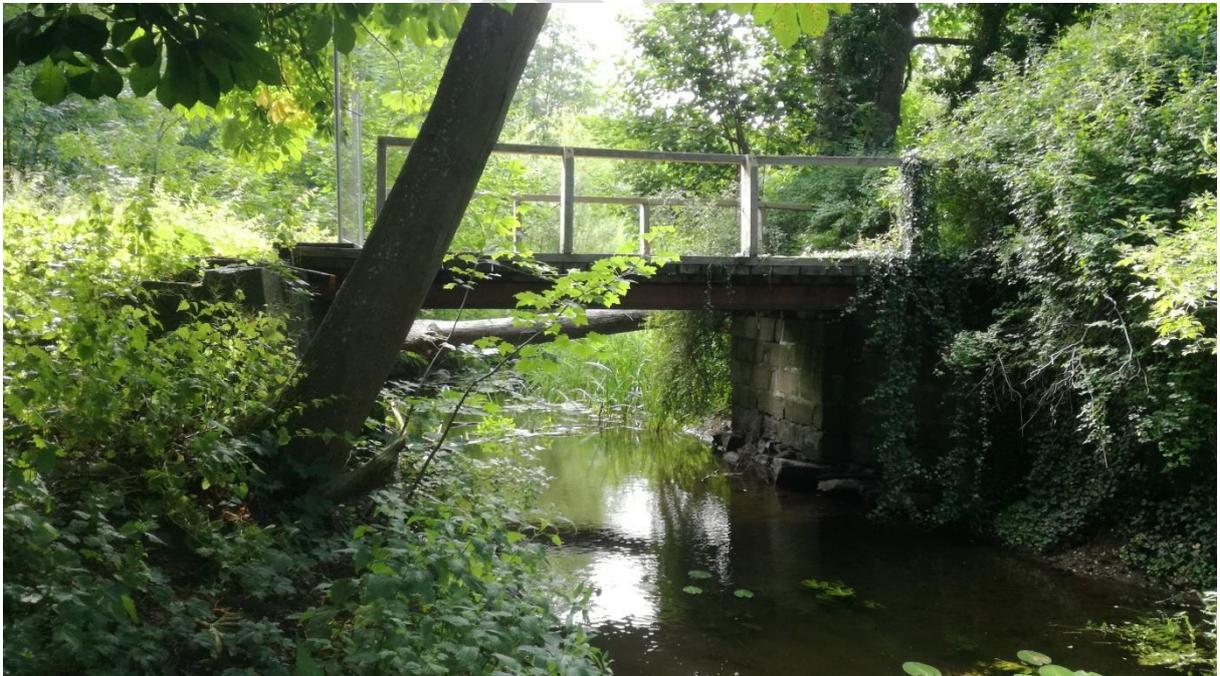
Brücke über Kossau mit Efeubewuchs, Blick Richtung Westen.
